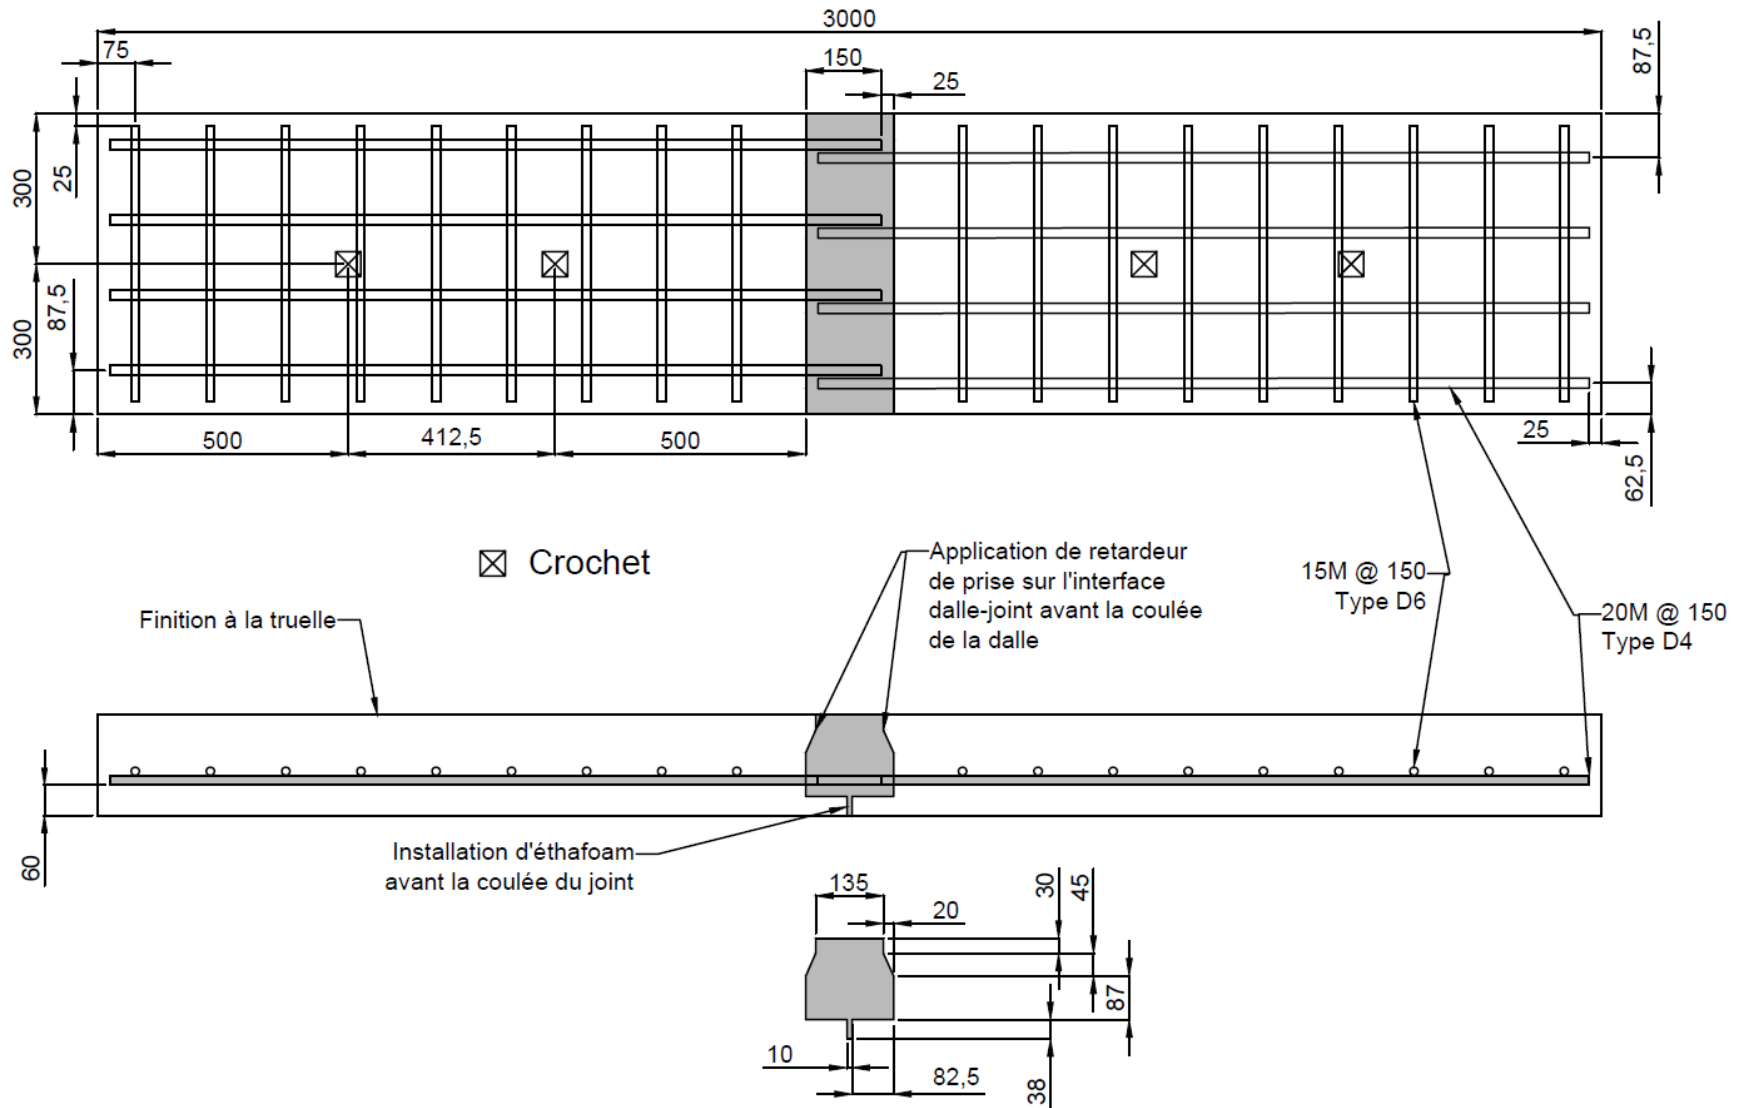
Dalle en BFHP avec joint de connexion longitudinale de 175 mm (Théorique)
